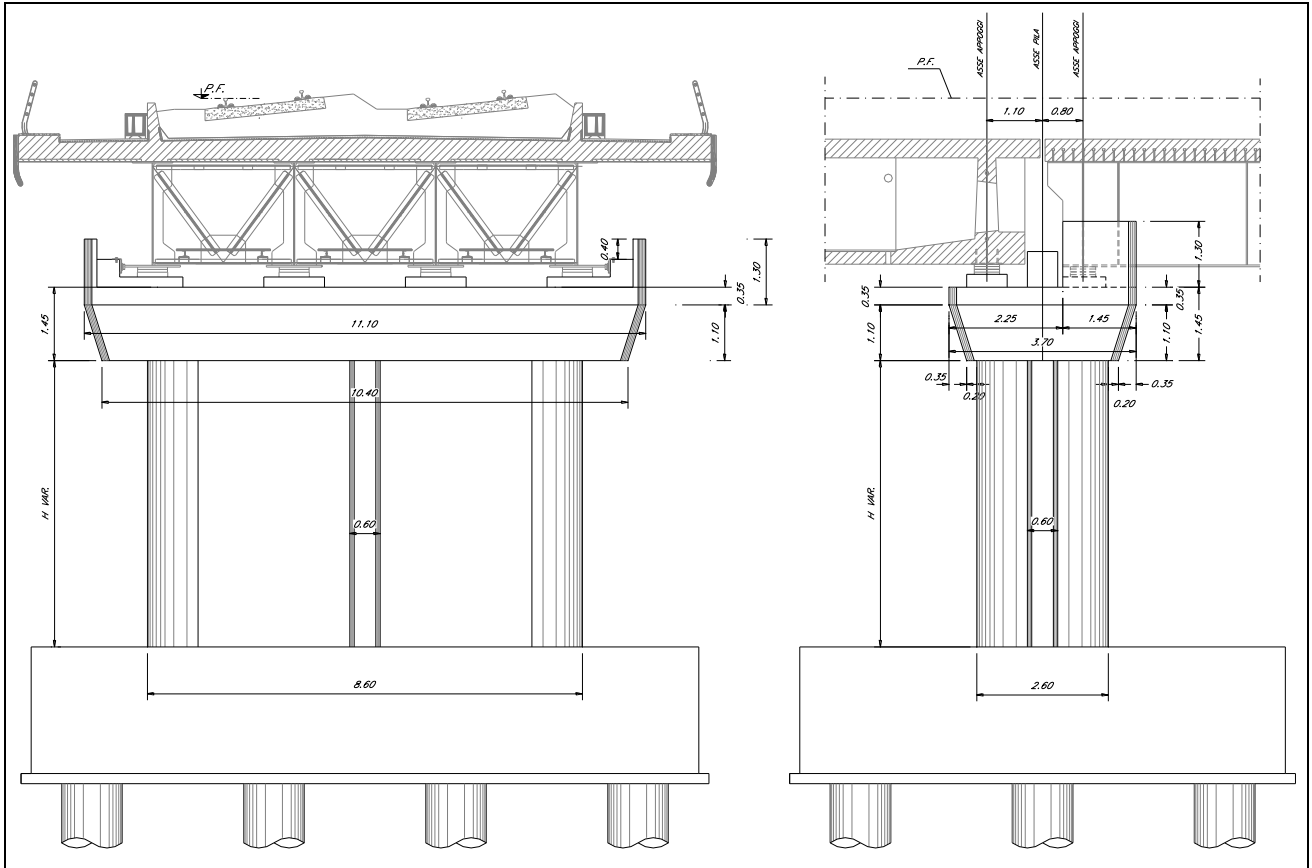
Viste pila di transizione da impalcato L=25.00m a impalcato L=34.00m
